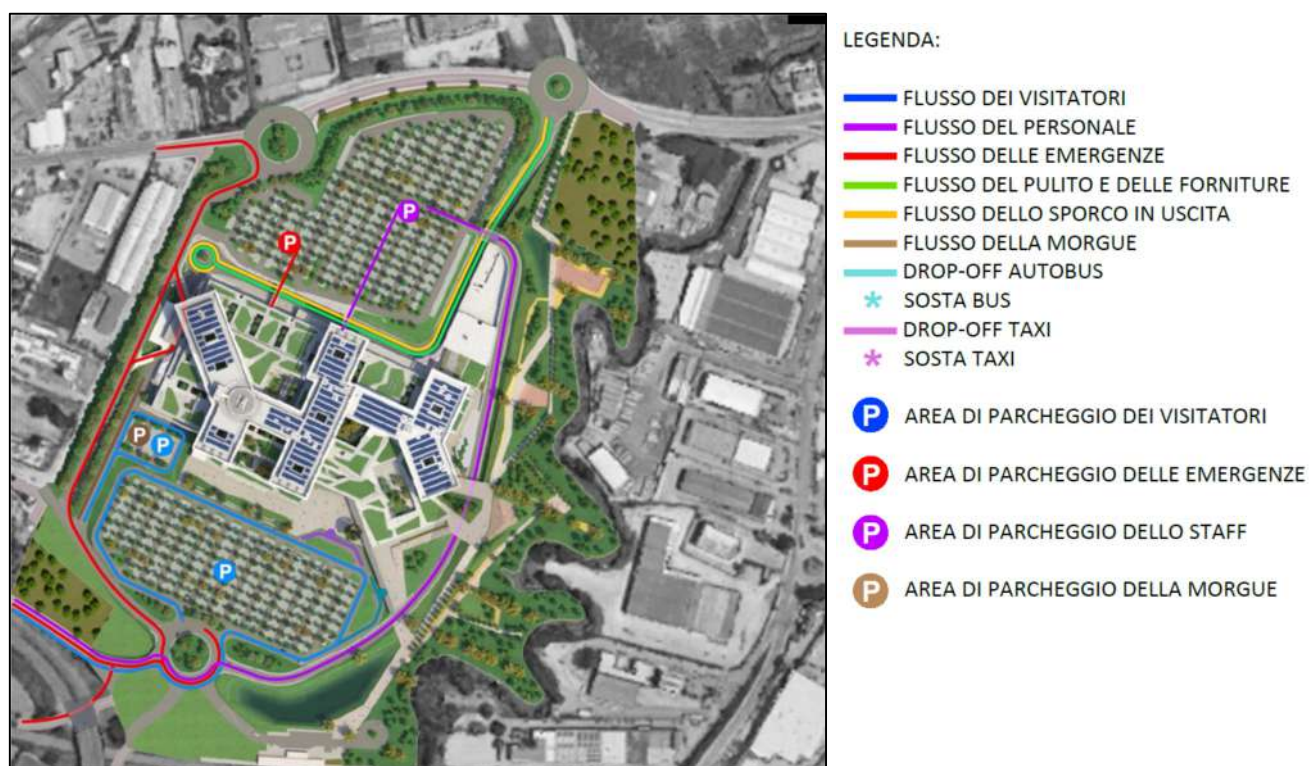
Masterplan di progetto (Fonte Studio Preliminare ambientale)
